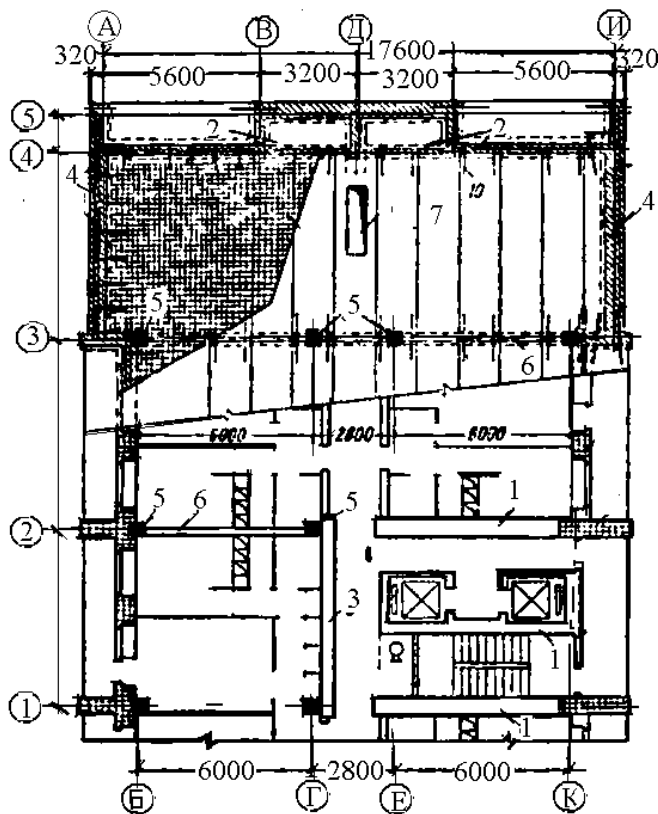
План 14-поверхового будинку з цегляними стінами та неповним каркасом: 1 – несучі внутрішні стіни, стіни сходової клітці; 2 – несуча зовнішня стіна; 3 – зв’яз-кова внутрішня стіна; 4 – зв’яз-кова зовнішня стіна; 5 – колони каркасу; 6 – ригелі; 7 – пенелі перекриття
